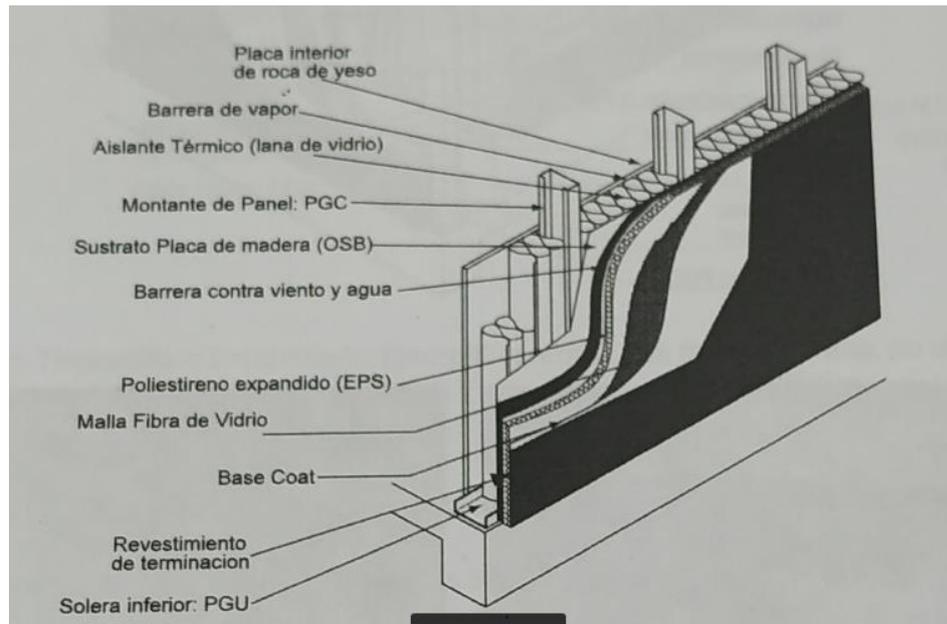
Composición de mampostería con sistema constructivo "Steel Framing". Fuente: Manual "Introducción al sistema Steel Framing" Autor: Arquitecto Esteban Jáuregui.
